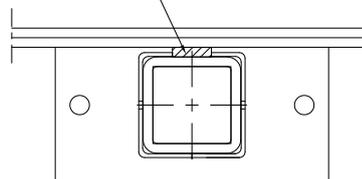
fissaggio del fermapiEDE con il montante attraverso un piatto da 5mm di spessore per la rimozione del parapetto
